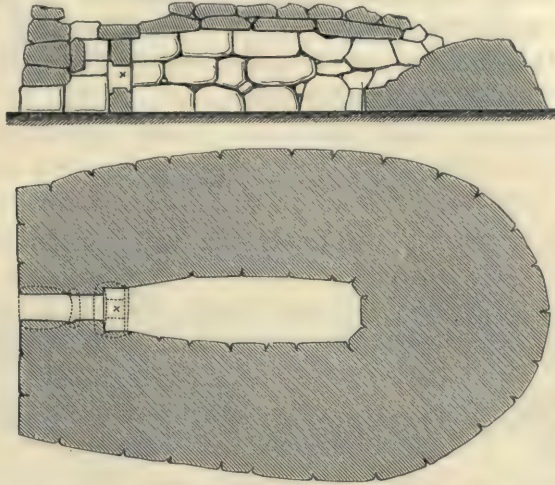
a u. b. Grab (»Naveta«) bei Rafal Rubi auf Menorca. Längsschnitt und Grundriss.
